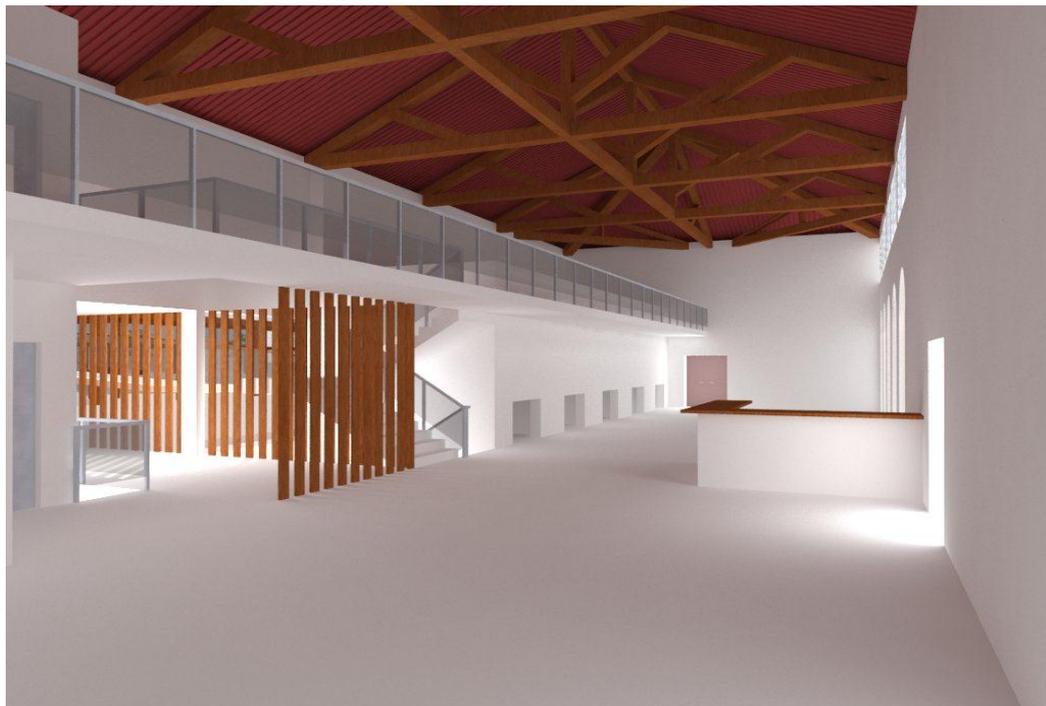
Vista interior da zona do r/chão do museu⁸⁷
